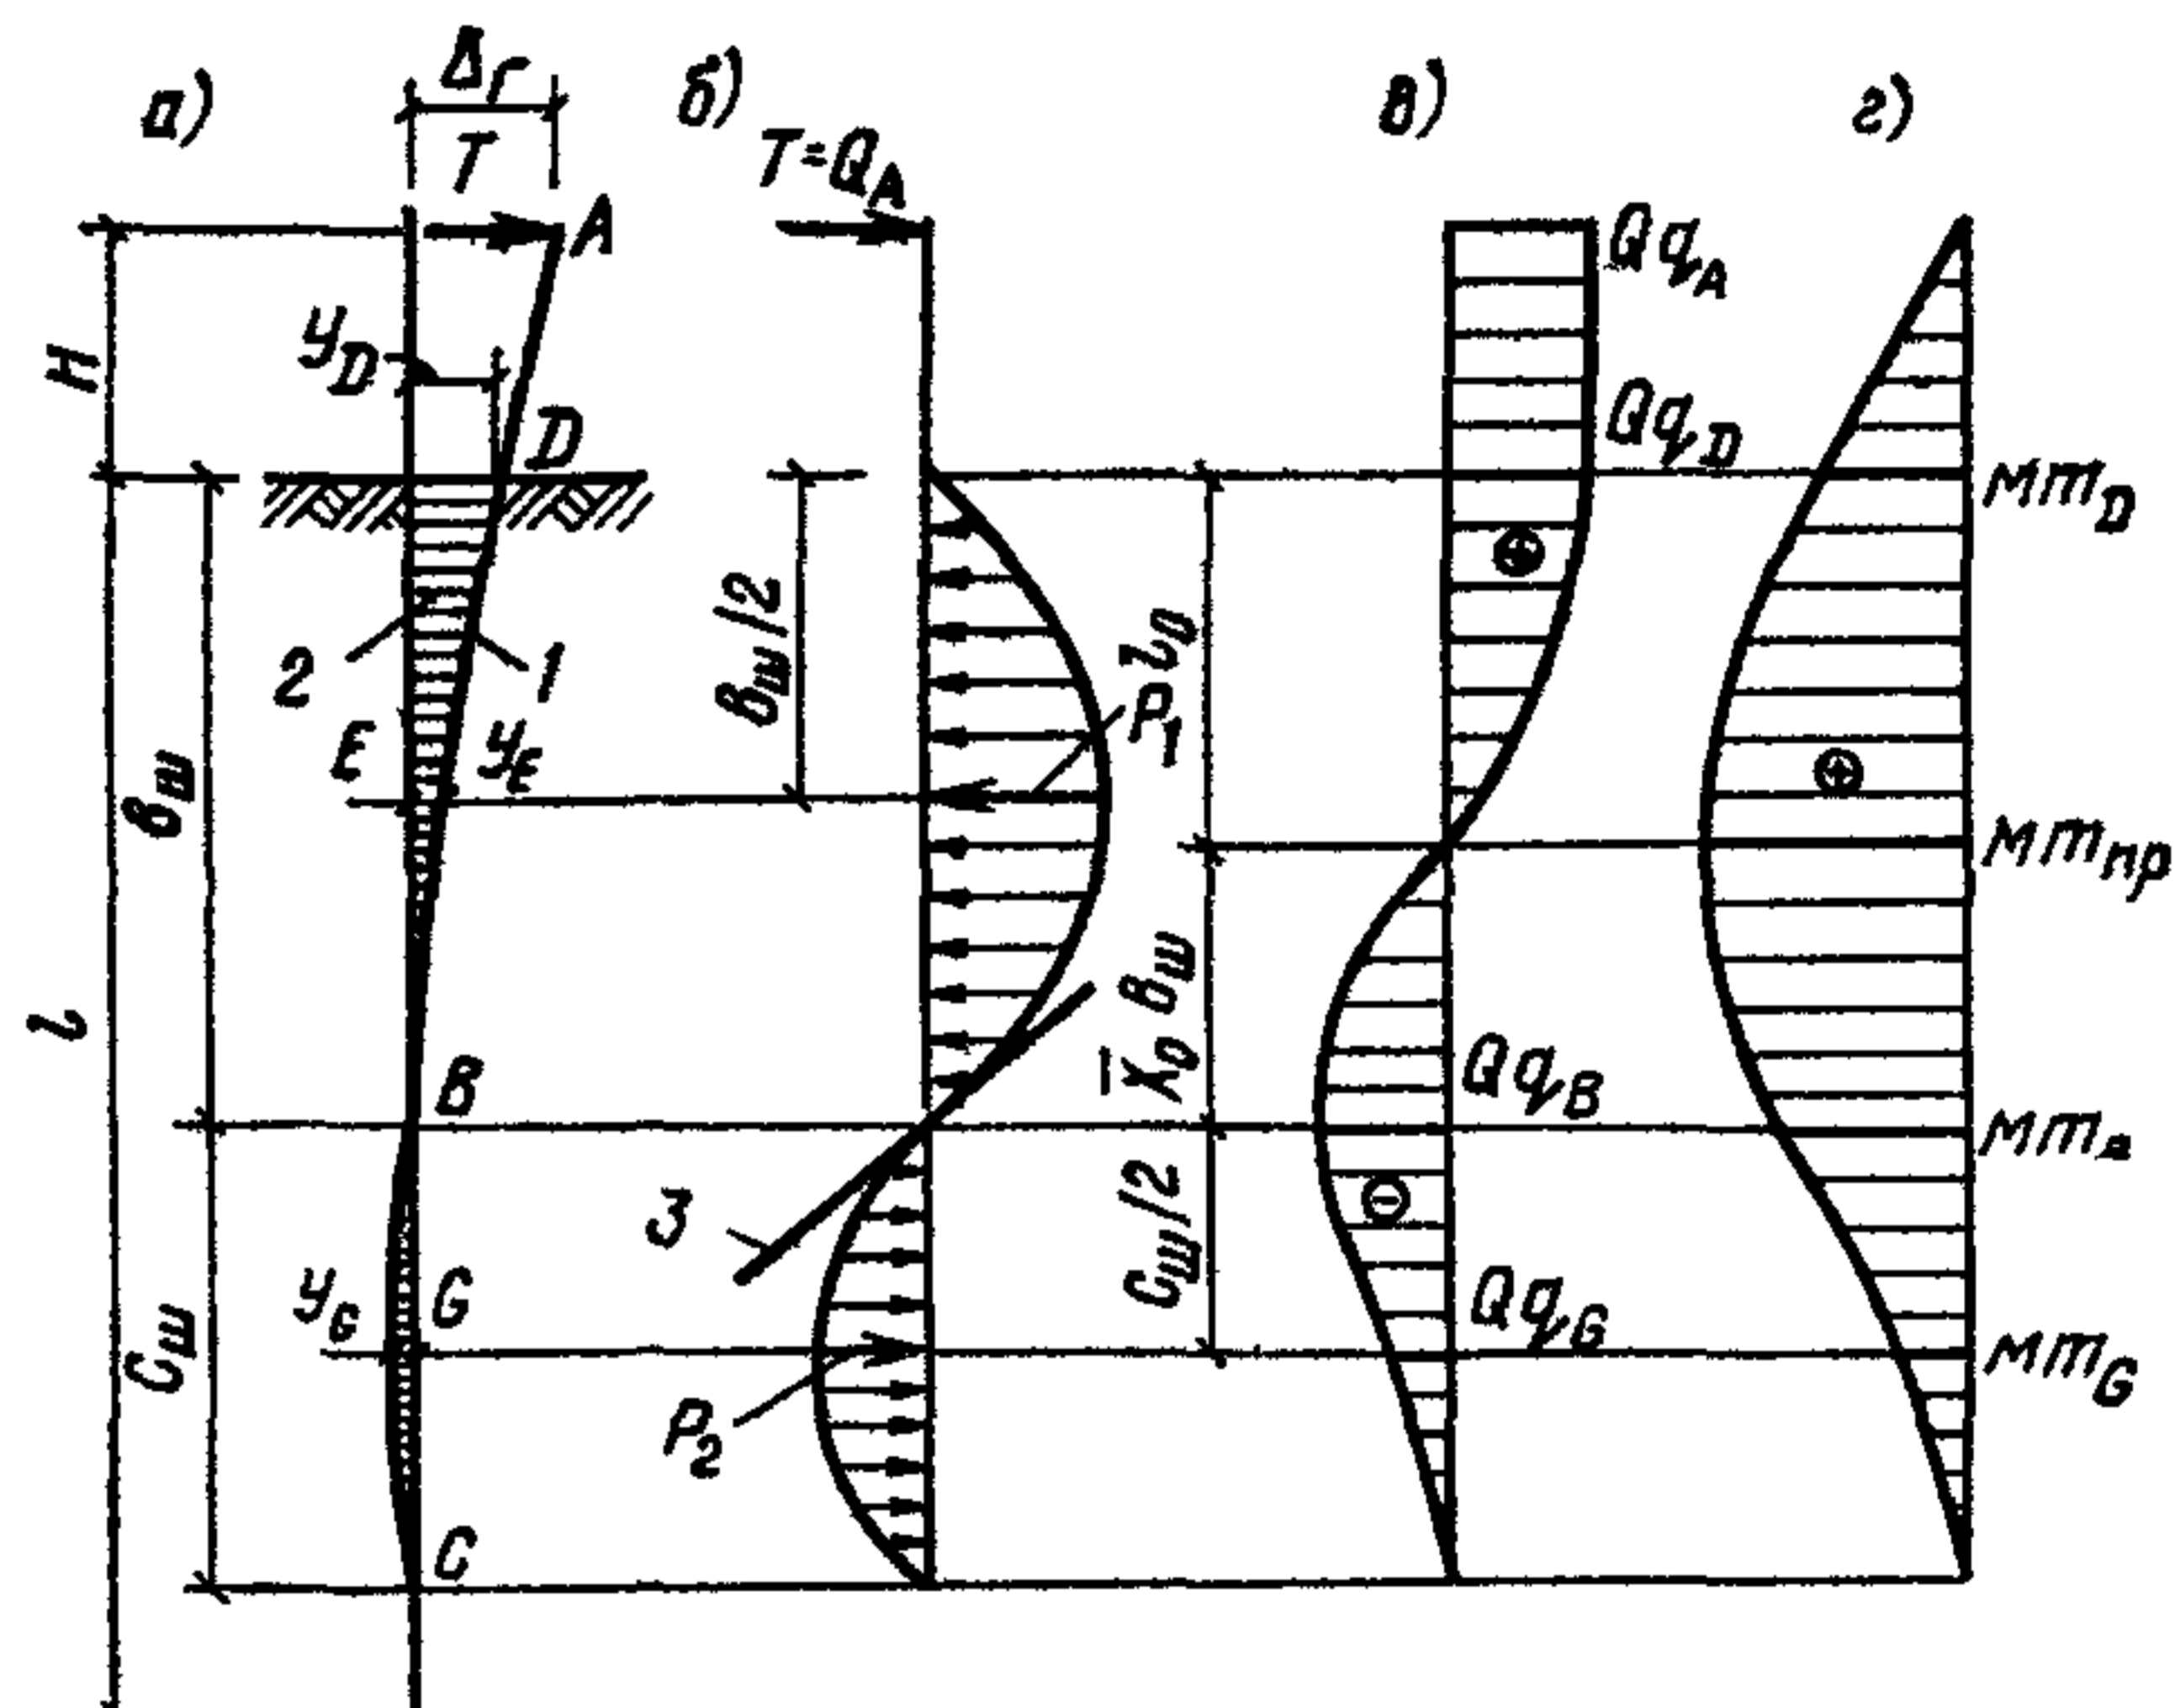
Схема взаимодействия упругой оси сваи, имеющей шарнирное сопряжение с ростверком, и грунта при действии горизонтальной нагрузки или перемещения
